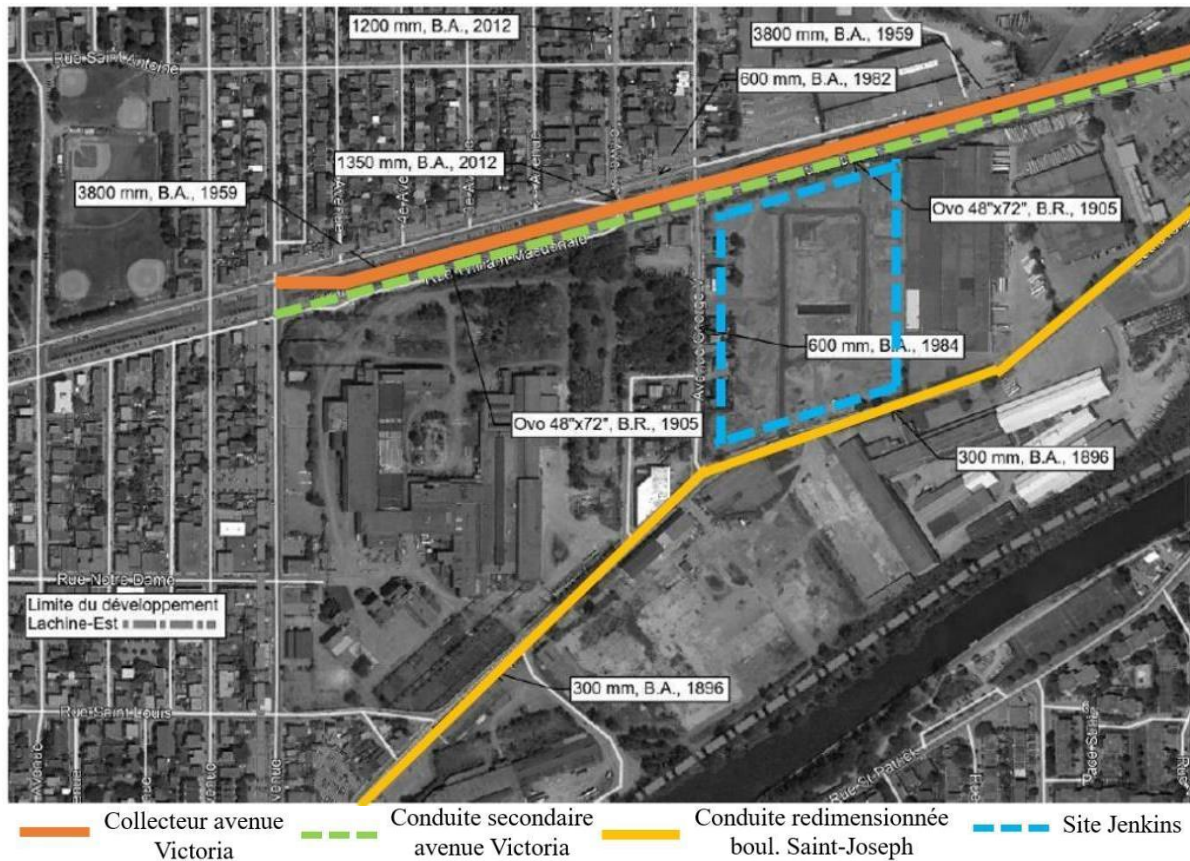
Conduites principales du réseau unitaire existant sur le secteur
